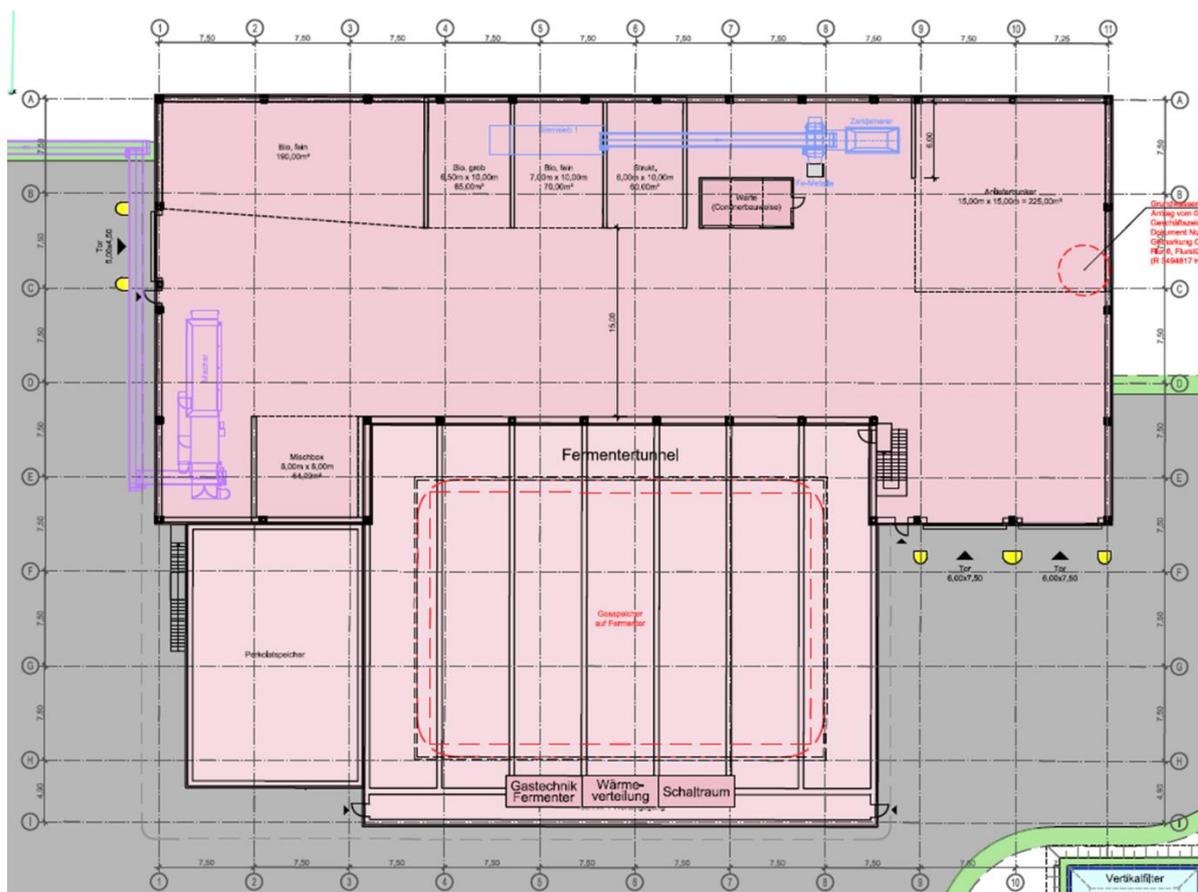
Planausschnitt Lageplan Standortlayout V1
